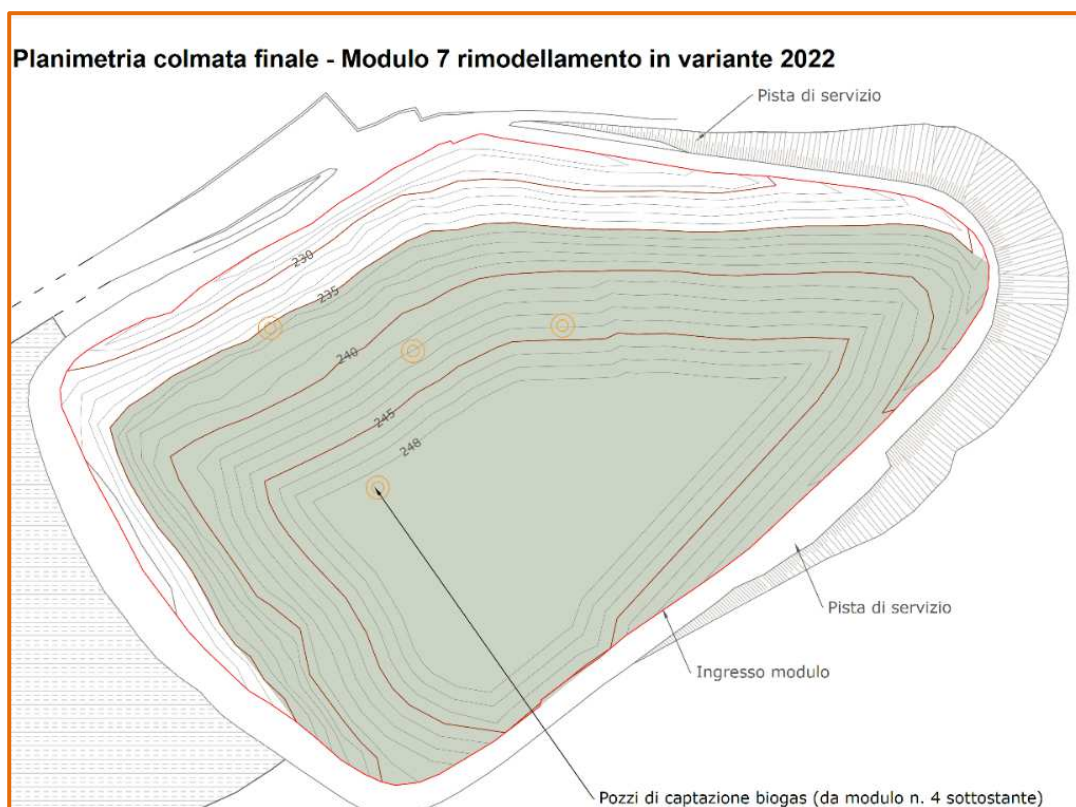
Planimetria delle sopraelevazioni del modulo 7 e del modulo 8
